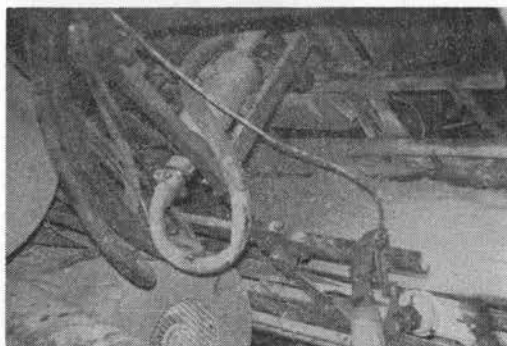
ざり出し (No. 2 ベルトコンベヤ)
